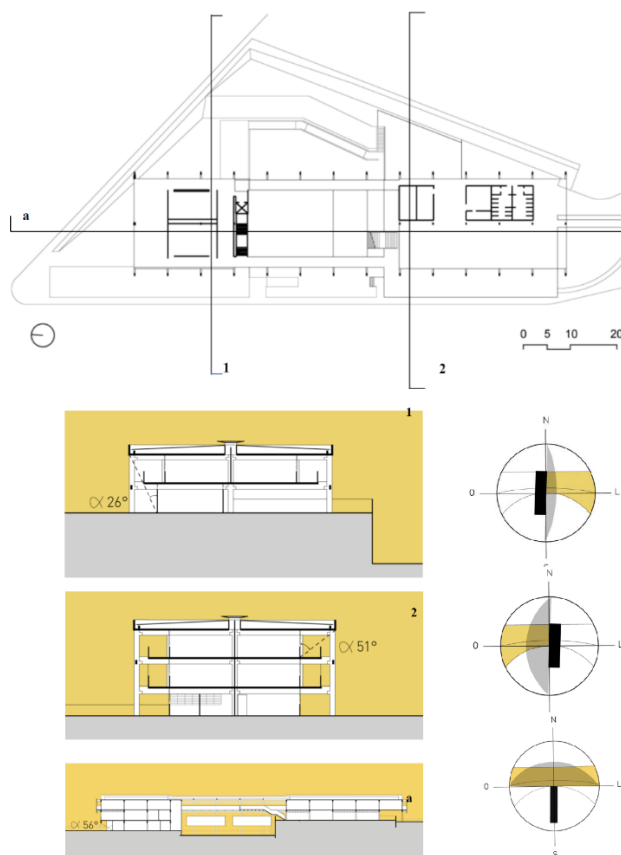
Planta baixa do 1º Pavimento com a simbolização das linhas de cortes para sombreamento e
